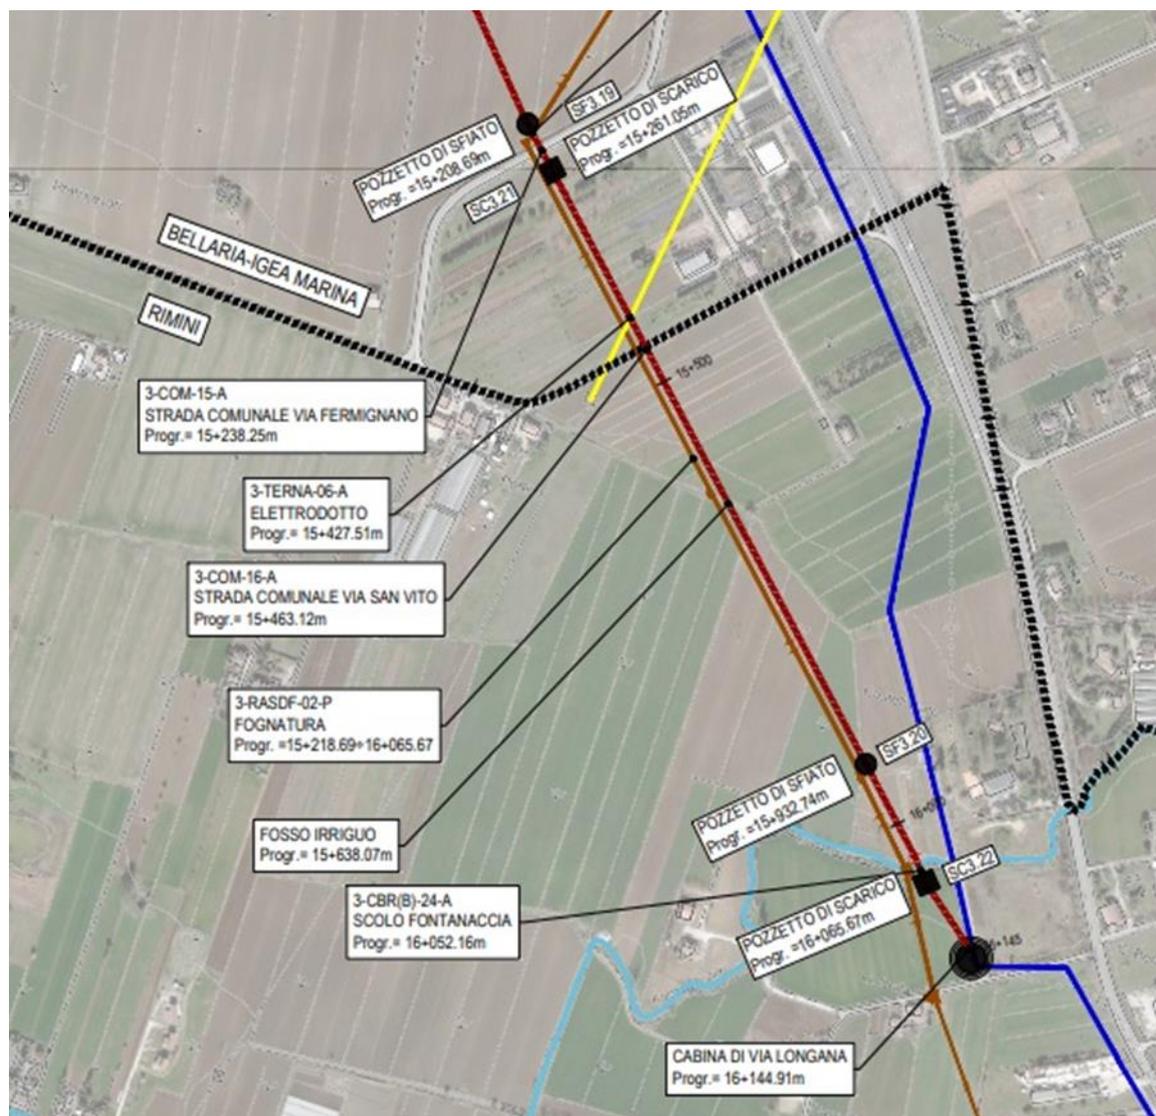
il tratto terminale del Lotto 3 con la connessione presso Torre Pedrera
